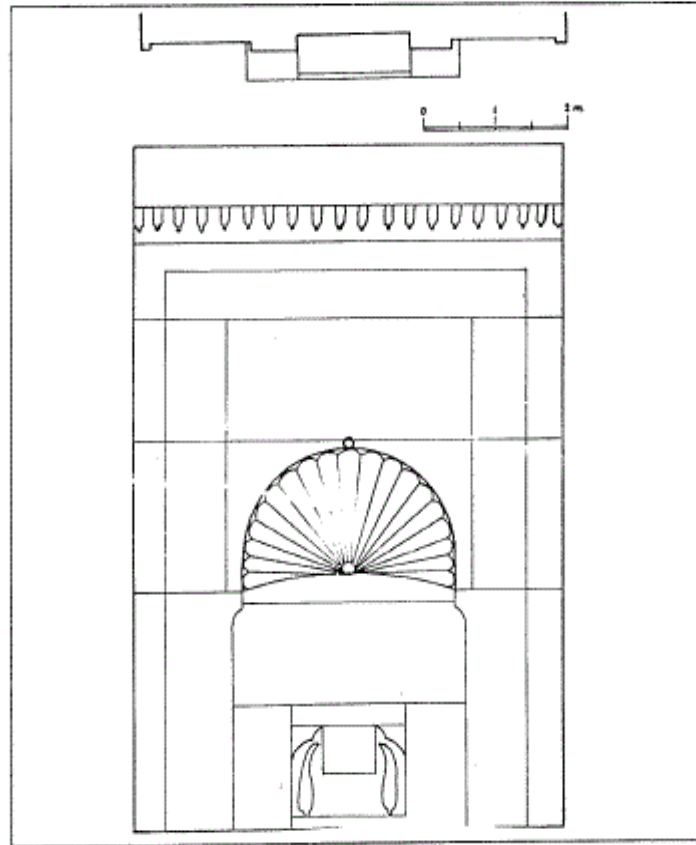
مسقط أفقي لجشمة سنان أغا باشا في أدونه (عن: ÖNGE).
